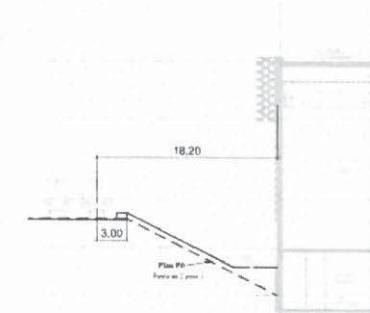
Coupe sur bâtiment RDC cote 171,45
